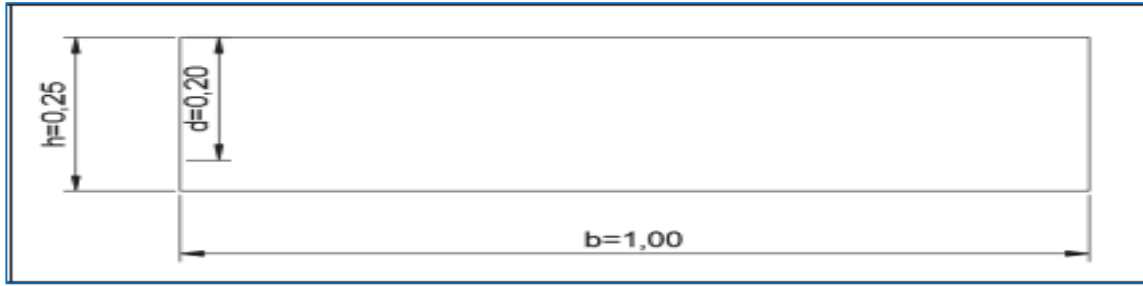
Section d'étude du ferrailage de la dalle.
